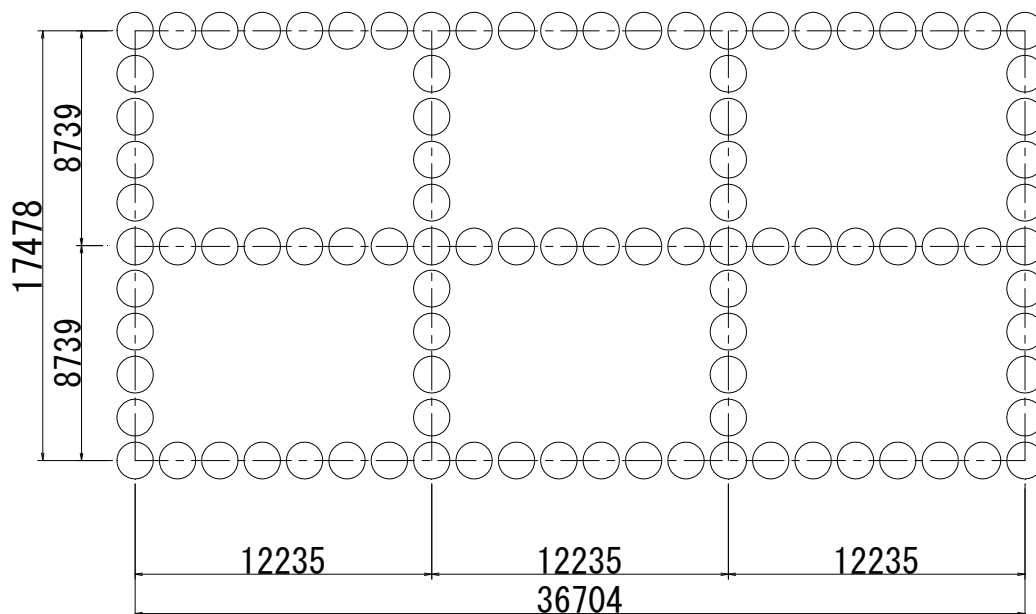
基礎形状図（詳細設計時断面）（MP2）
